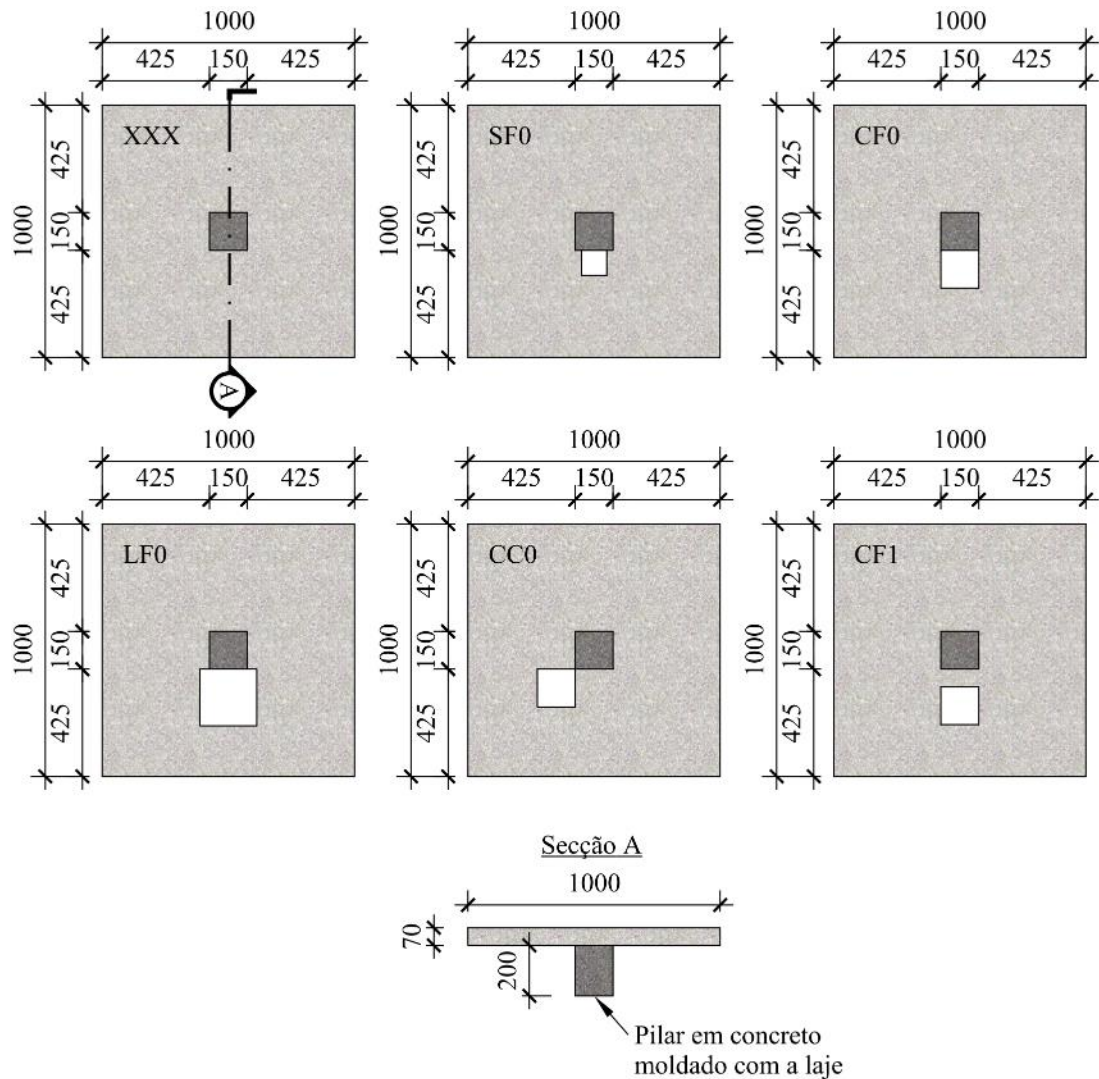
Geometria das lajes de OUKAILI e SALMAN (2014)
